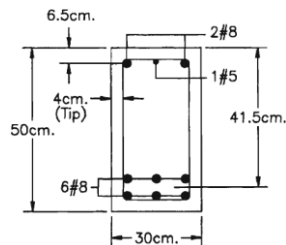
Ejemplo de sección típica de viga peraltada²³
